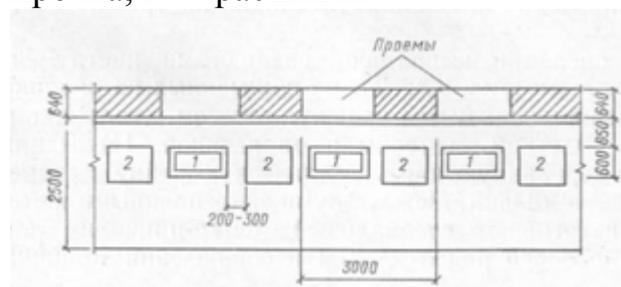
Типовая схема размещения материалов на рабочем месте при кладке стен с проемами 1 — ящик с раствором; 2 — поддон с кирпичом
